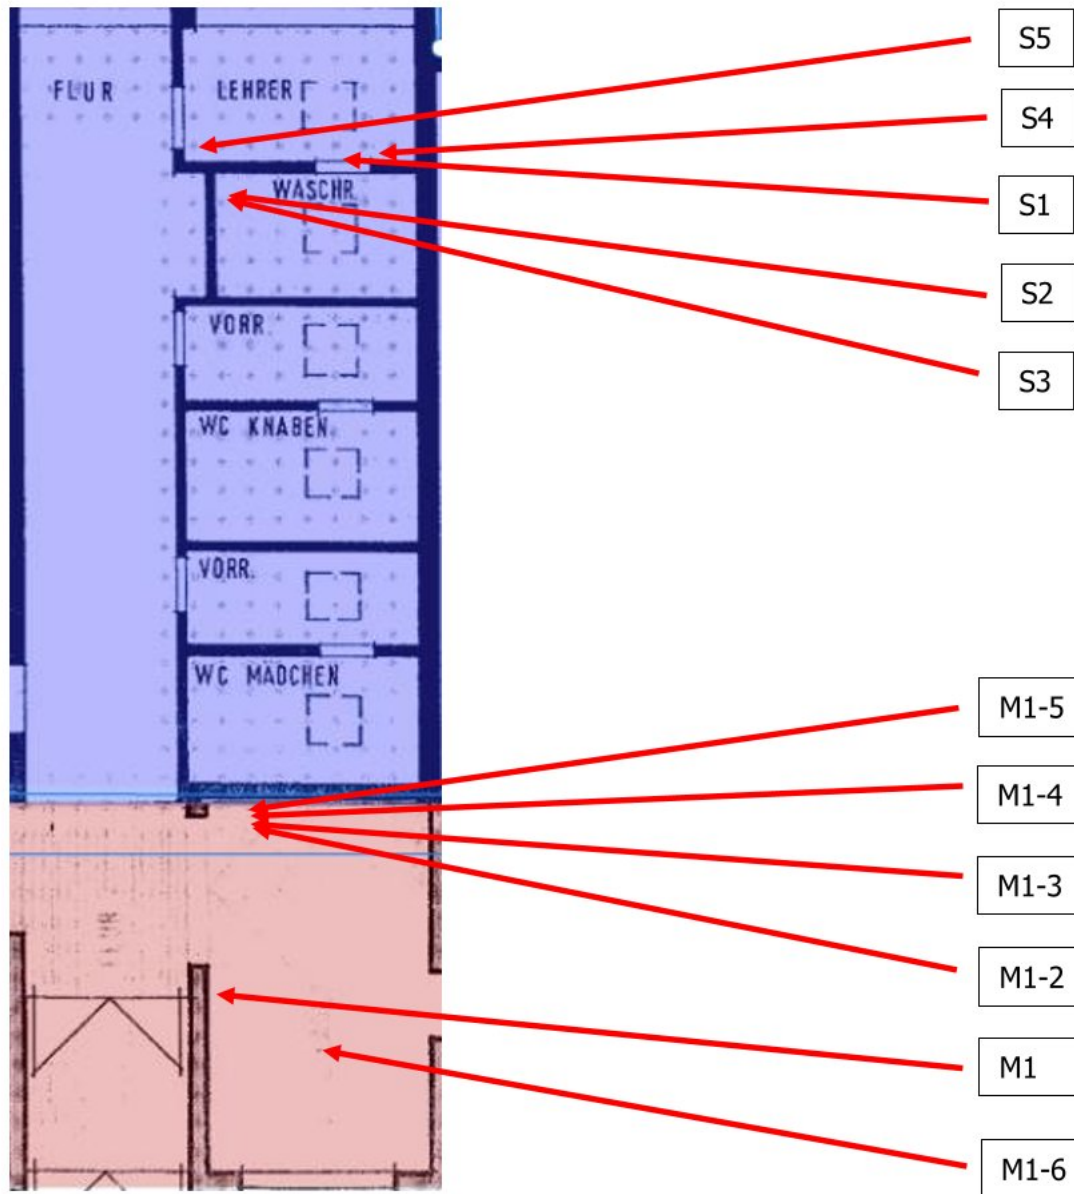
Teilbereich (siehe Grundriss).
